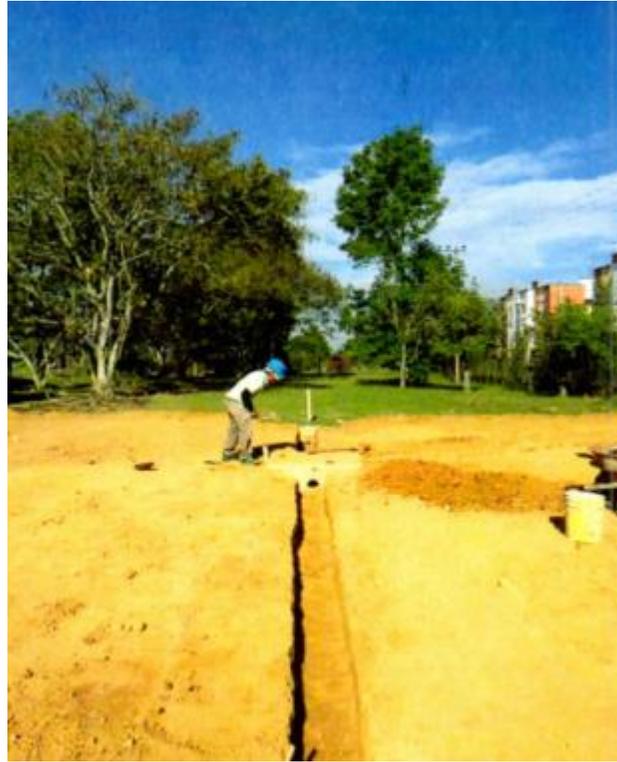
Excavación a mano para Tuberías de drenaje (3/3).
